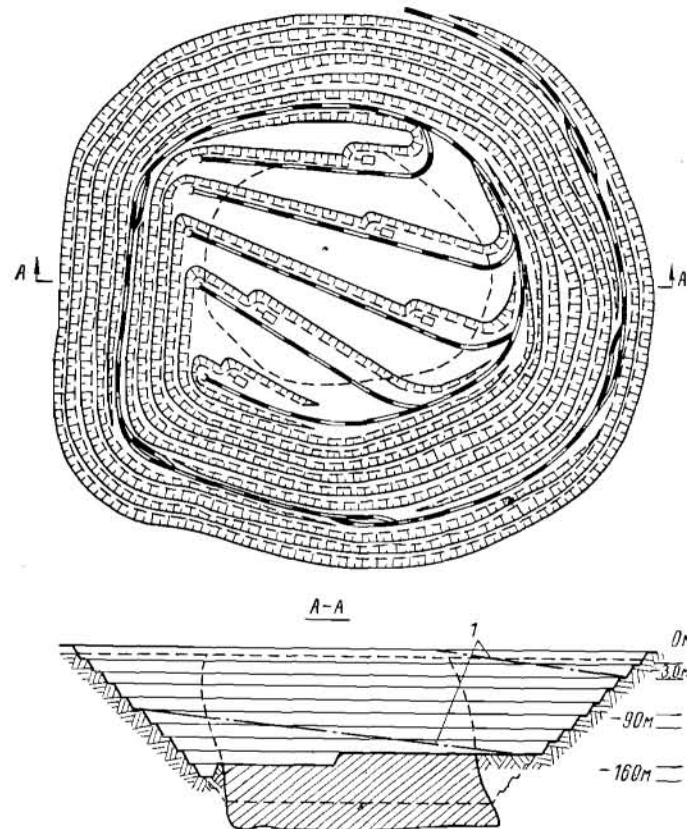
Схема вскрытия общими внутренними траншеями спиральной формы:
